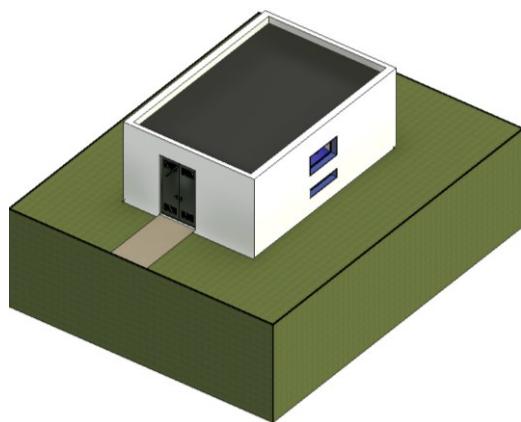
Modelo tridimensional da Estação Elevatória em Revit
